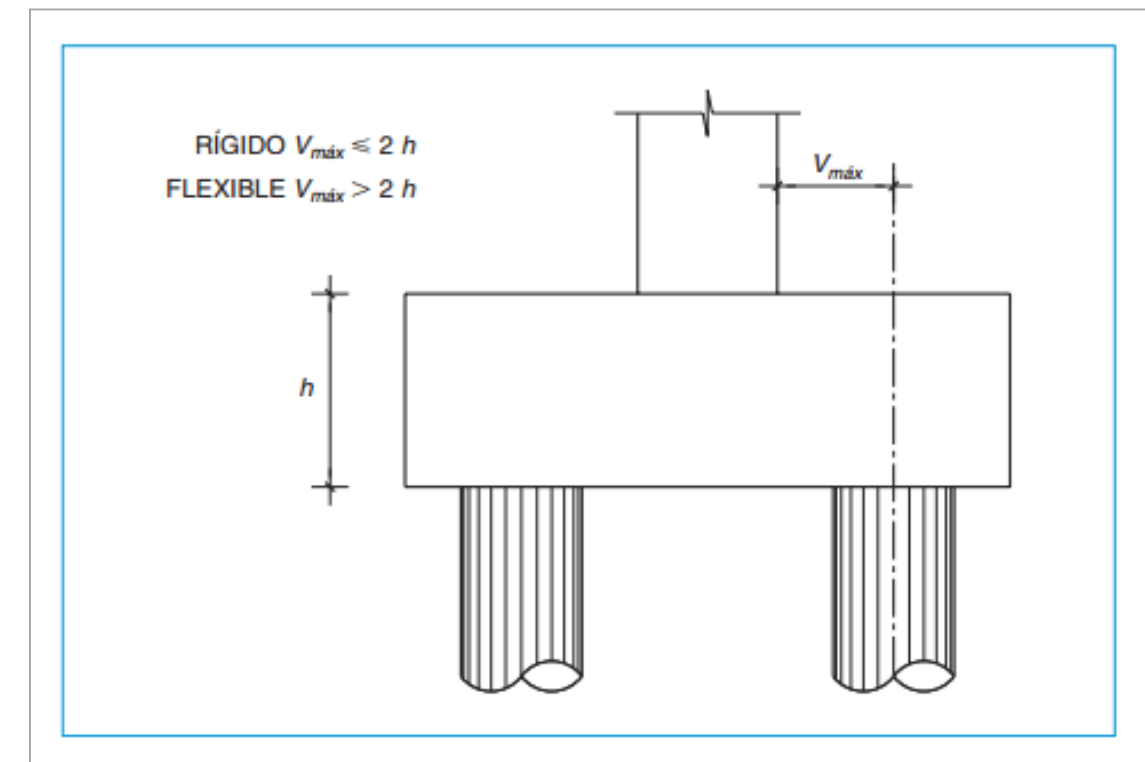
Distinción entre encepado rígido y flexible. Fuente: Instrucción de Hormigón Estructural EHE-08.
